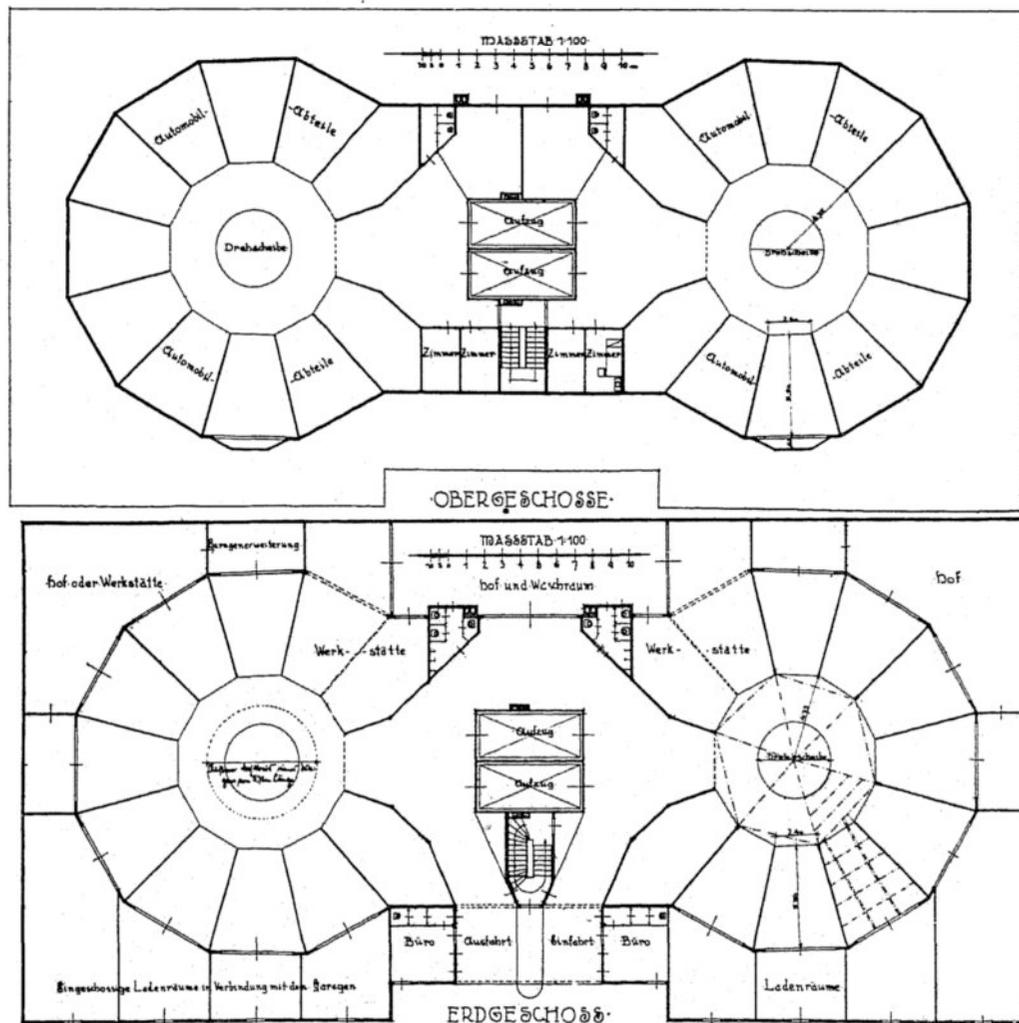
Kraftwagenhaus Bauart Pistor (Grundrisse).
